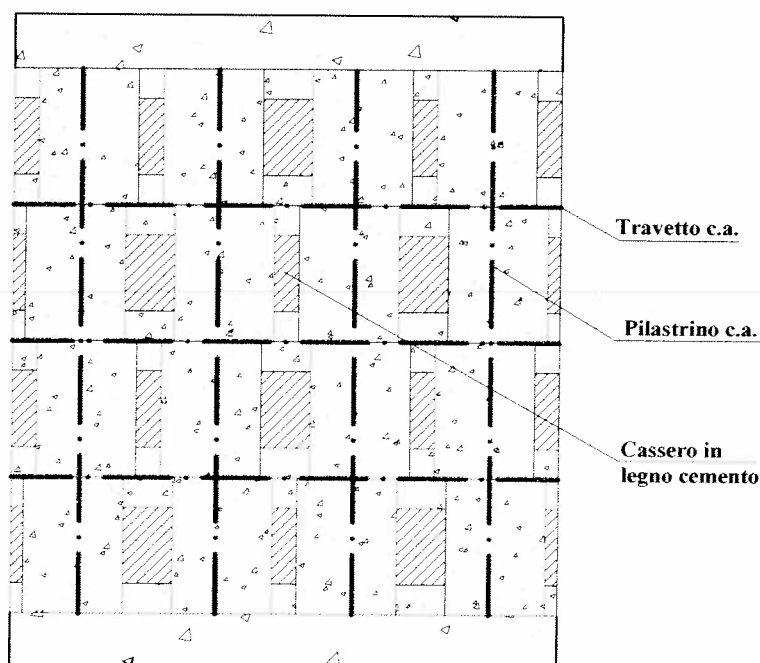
Elementi portanti verticali (pilastrini) ed orizzontali (travetti) all'interno del pannello soggetto a prove di compressione.
